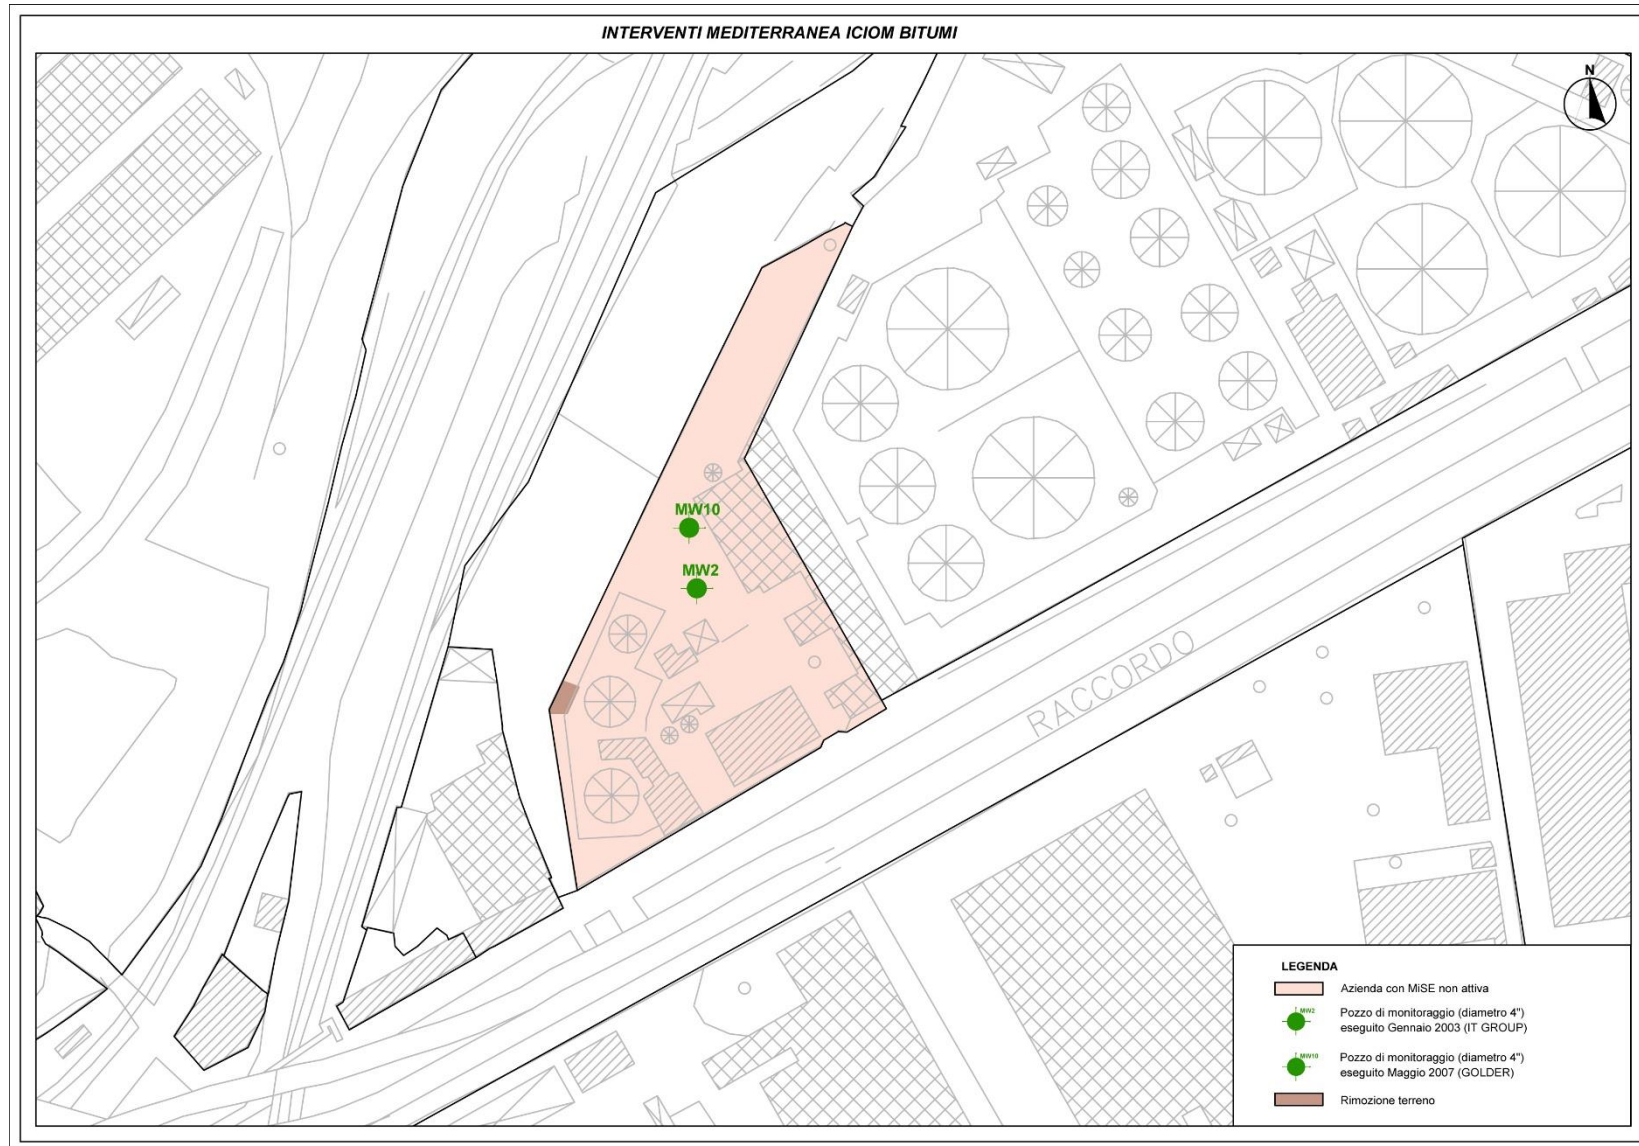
Planimetria intervento MISE – Mediterranea ICIOM
